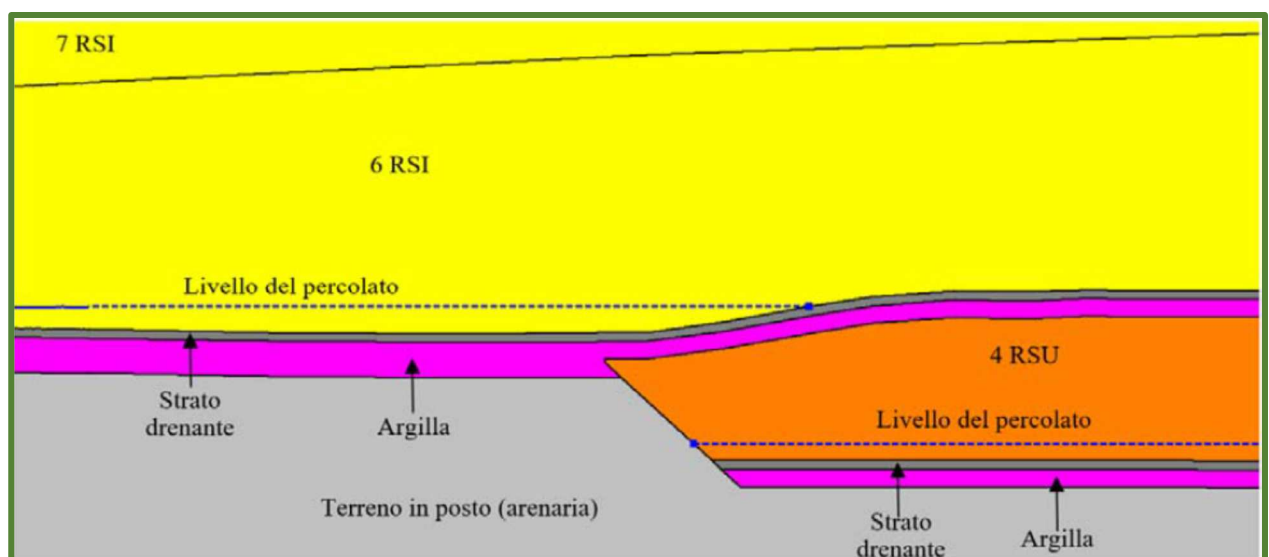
/III – Sezione A-A' – Sponda nord-est - Particolare 2
